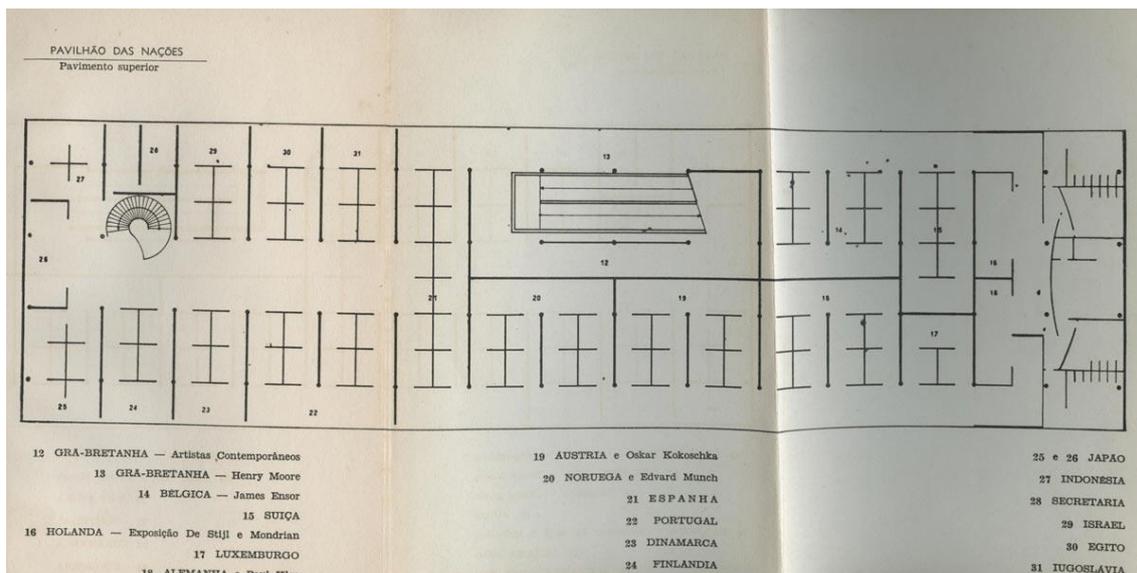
Planta de layout do pavimento superior do Pavilhão das Nações na II Bienal de São Paulo. Fonte: Bienal.
